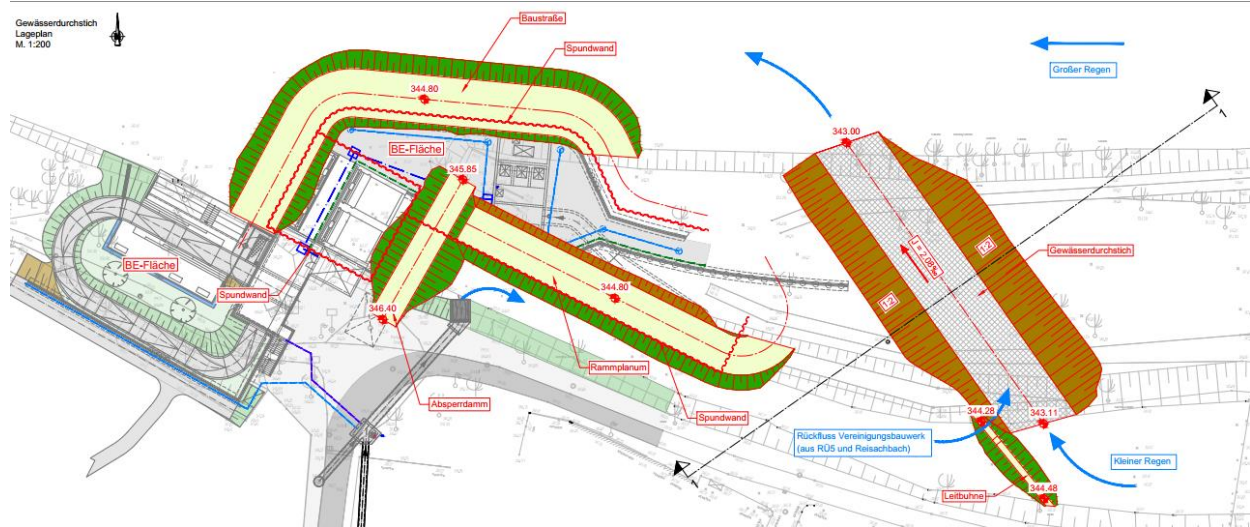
Systemplan für bauzeitl. Gewässerdurchstich und Baustraßen, Auszug (Quelle: IB Schlegel, 2021, Anlage Nr. 3.7.2.2)
